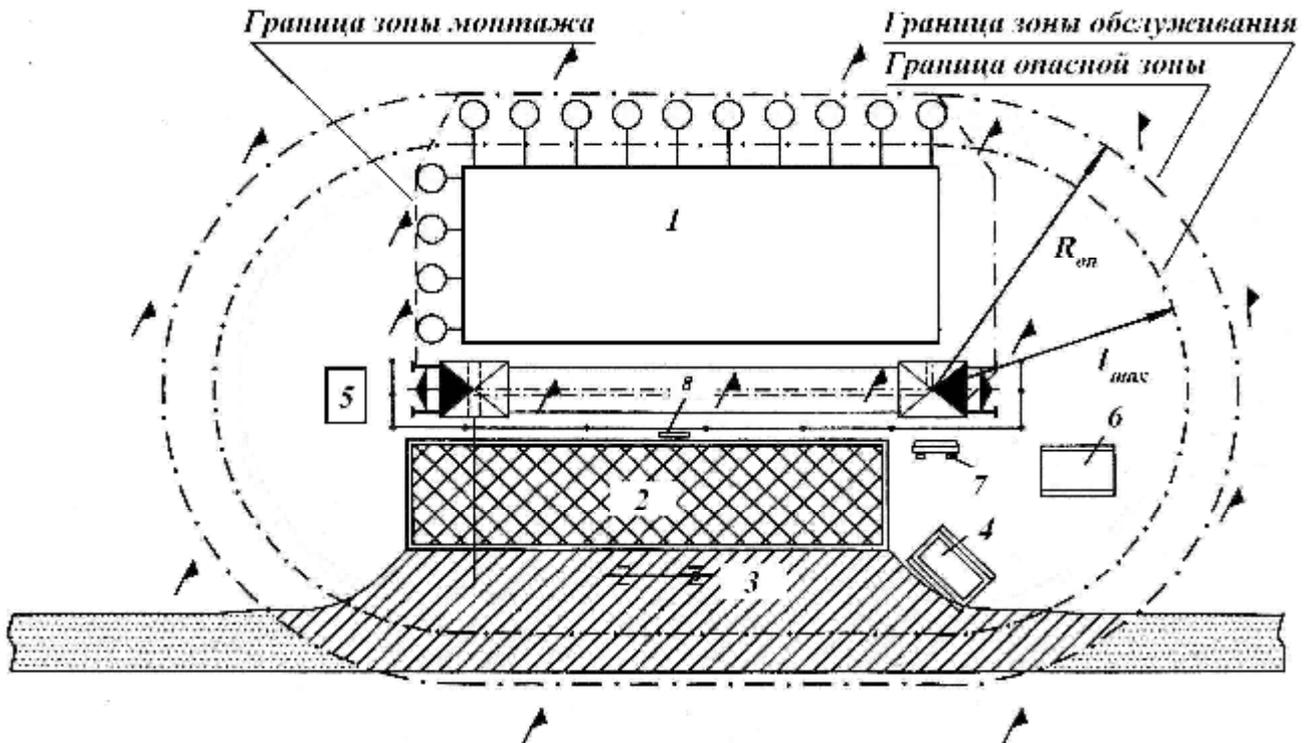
Схема размещения элементов СГП внутри опасной зоны работы крана на рельсовом ходу: 1 – строящееся здание; 2 – площадка для складирования; 3 – площадка для разгрузки автотранспорта; 4 – площадка для приёма раствора; 5 – место нахождения контрольного груза; 6 – место хранения грузозахватных приспособлений и тары; 7 – стенд со схемами строповки грузов; 8 – шкаф электропитания крана
